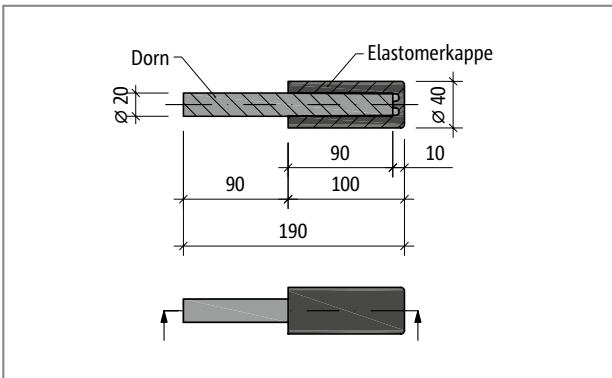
Schöck Tronsole® Typ D: Produktgrundriss
